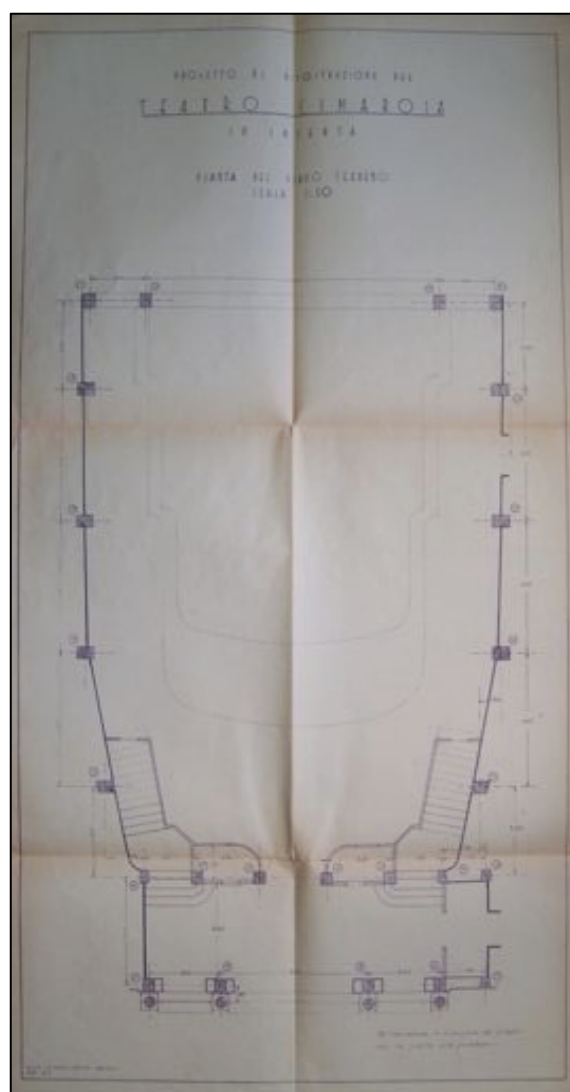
Progetto di ricostruzione del Teatro Cimarosa del 1934, pianta della I balconata (ASCe, Fondo Genio Civile, cat.10, f. 1109)
